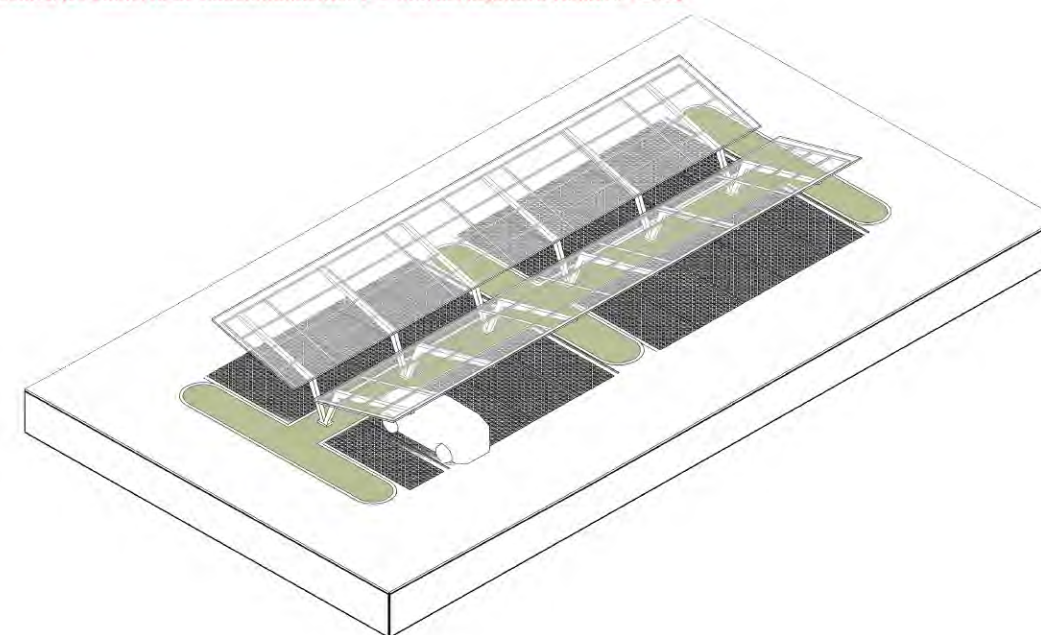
"Despiece cubierta estacionamientos". © María Alejandra Romero | 2024
